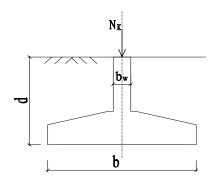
上部结构传至基础的线荷载的作用位置
